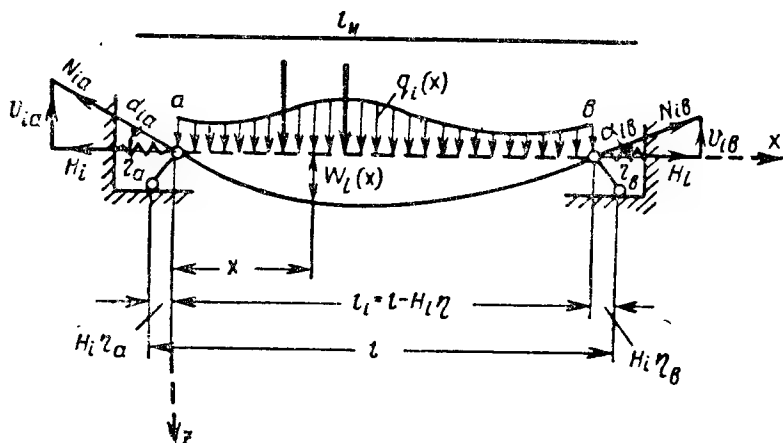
Расчетная схема полосы, вырезанной из мембраны на двух упругих опорах с произвольной нагрузкой
